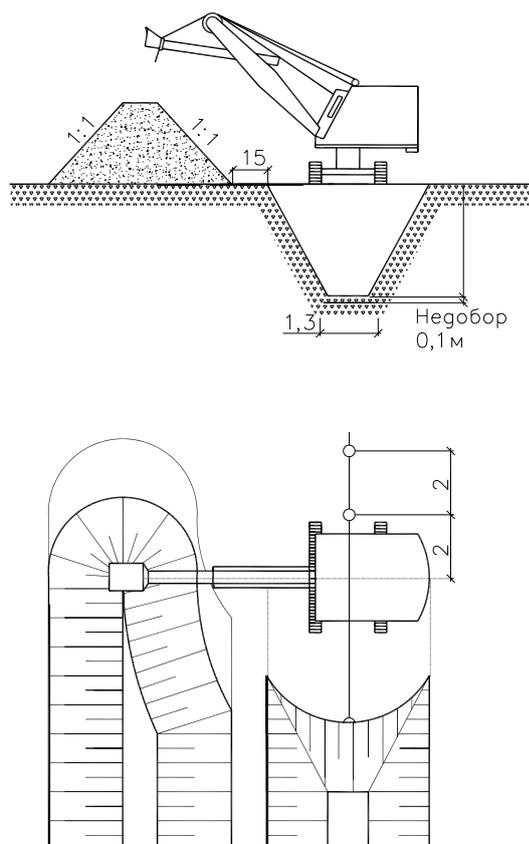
Технологическая схема продольной разработки отсыпкой грунта в отвал
